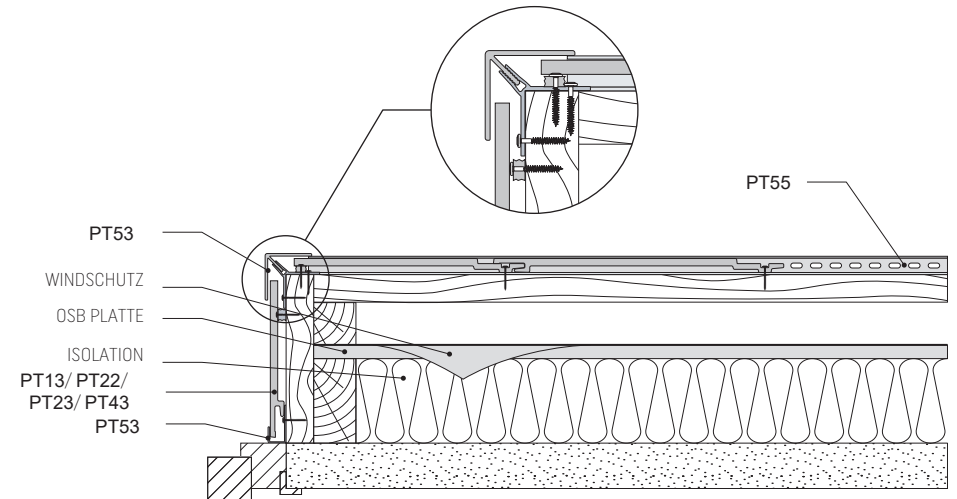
Detail, Ecke, Holzelemente an der Mauer mit Wärmeisolationsschicht - horizontaler Schnitt
